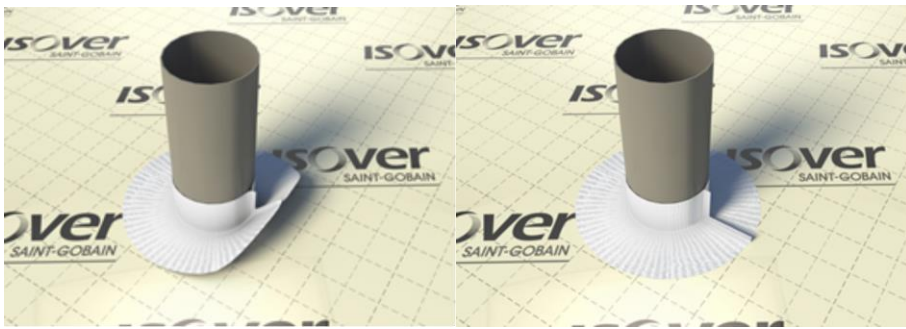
Pose de l'adhésif Isostretch autour d'un conduit en collant la jonction adhésif sur adhésif
